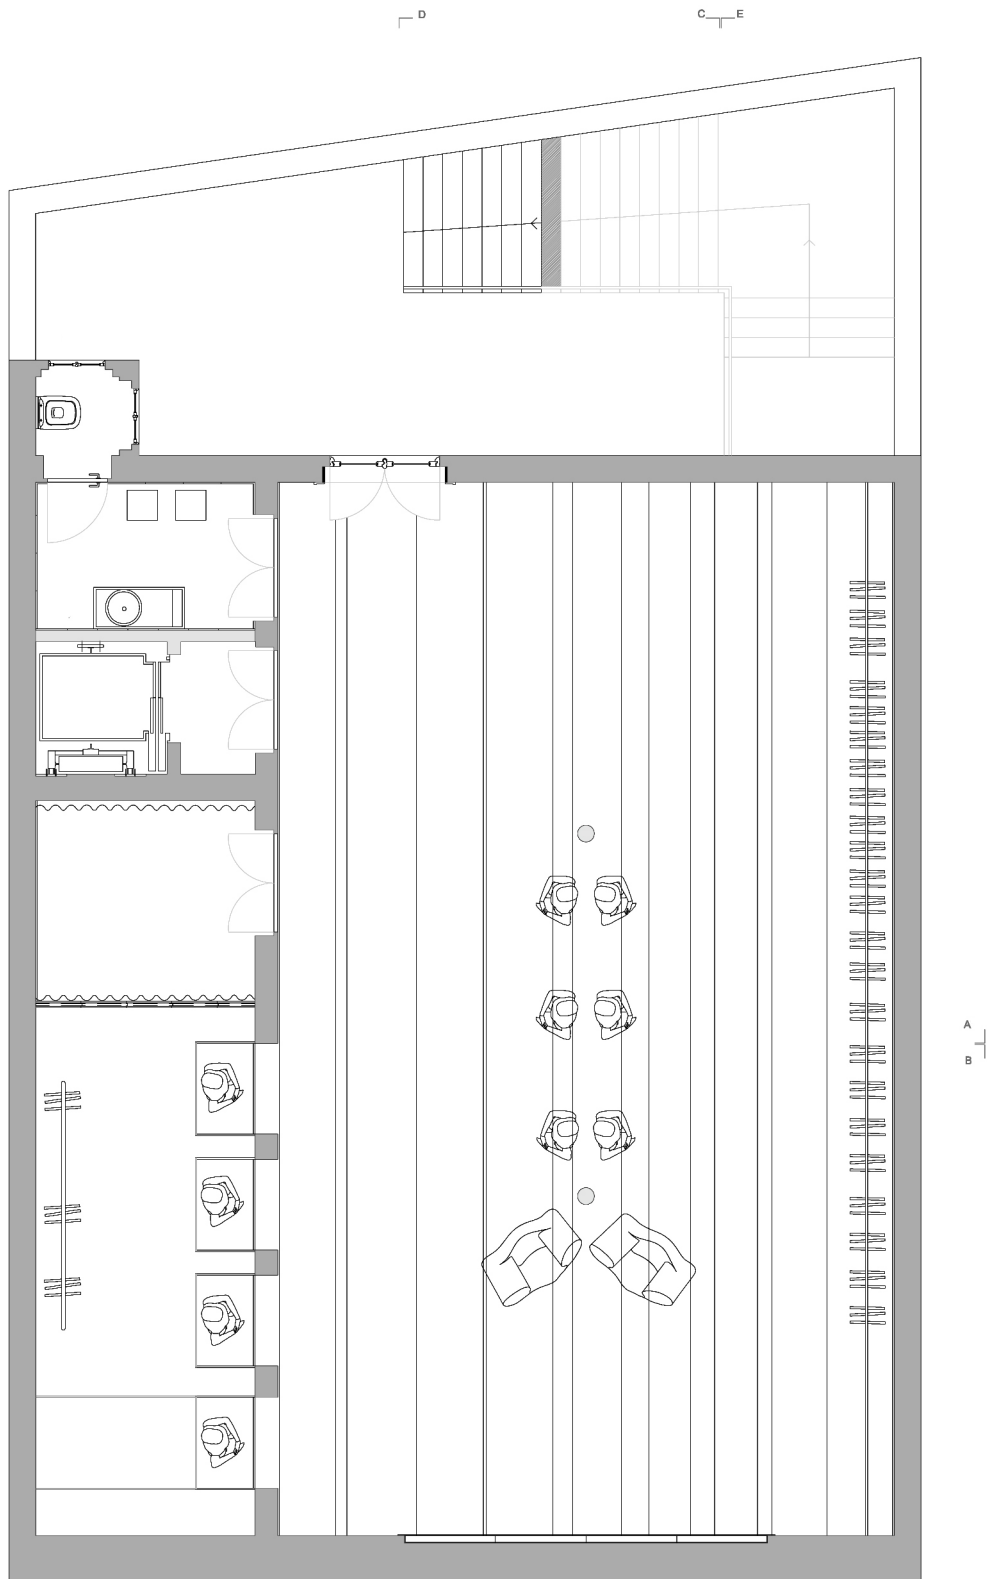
Planta do ponto de venda na cave escala 1/100.
